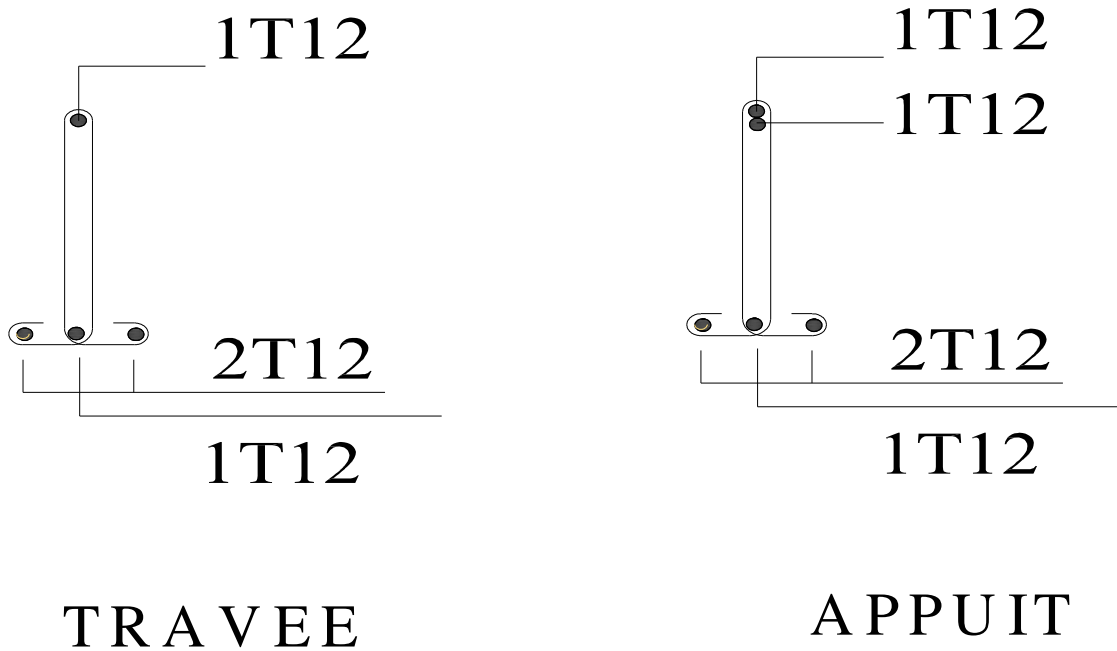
Schéma De Ferrailage Des Poutrelles.
